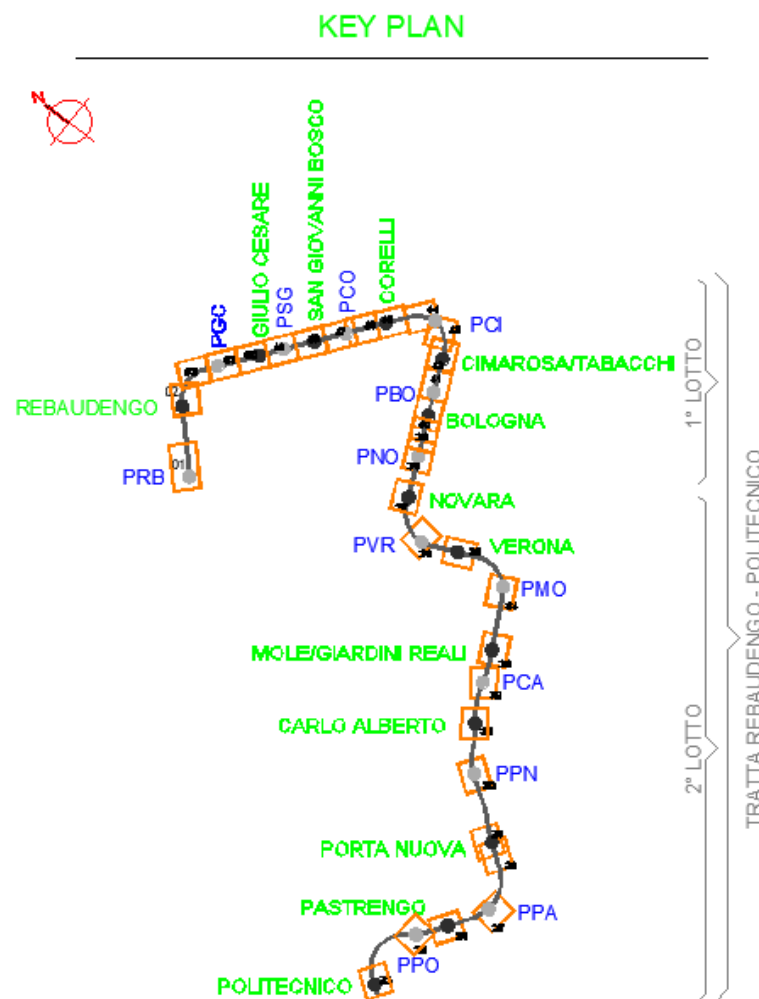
Key-plan della linea 2 – tratta funzionale Politecnico – Rebaudengo
